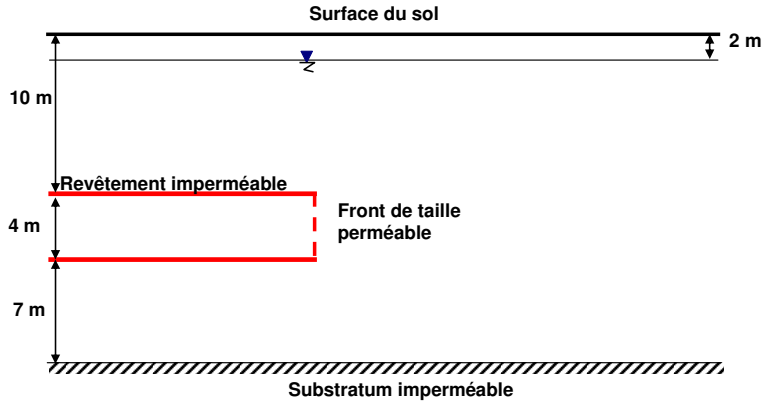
Coupe en long du tunnel, avec les conditions aux limites hydrauliques
